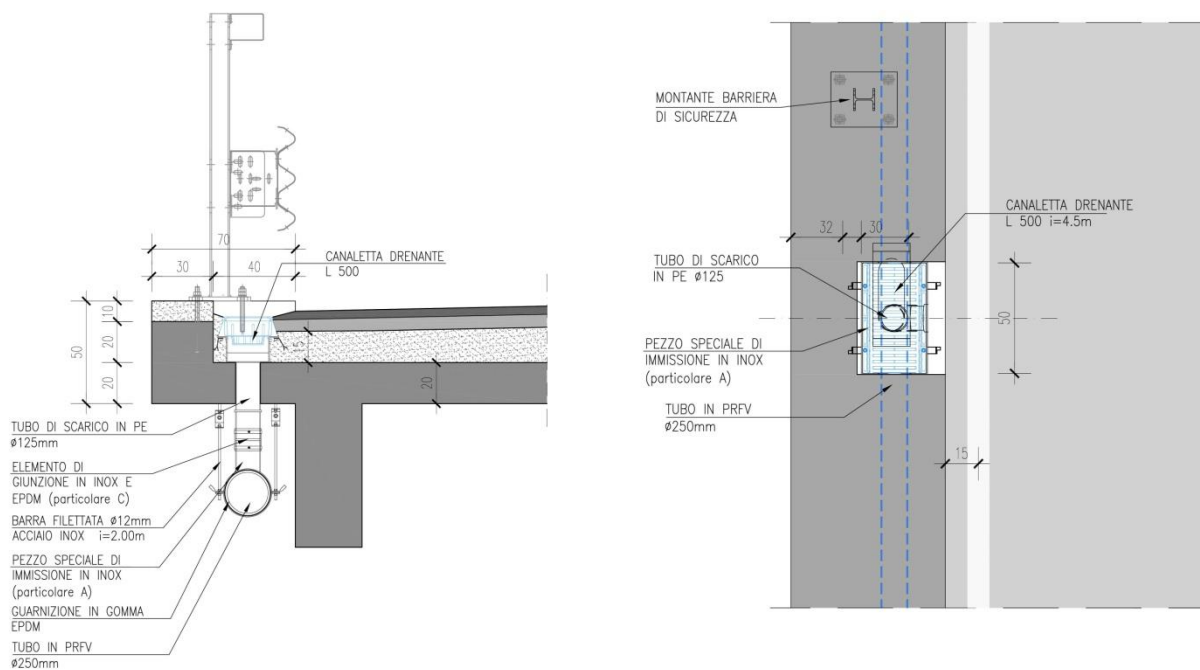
Schema scarico dalla caditoia alla condotta di collettamento
